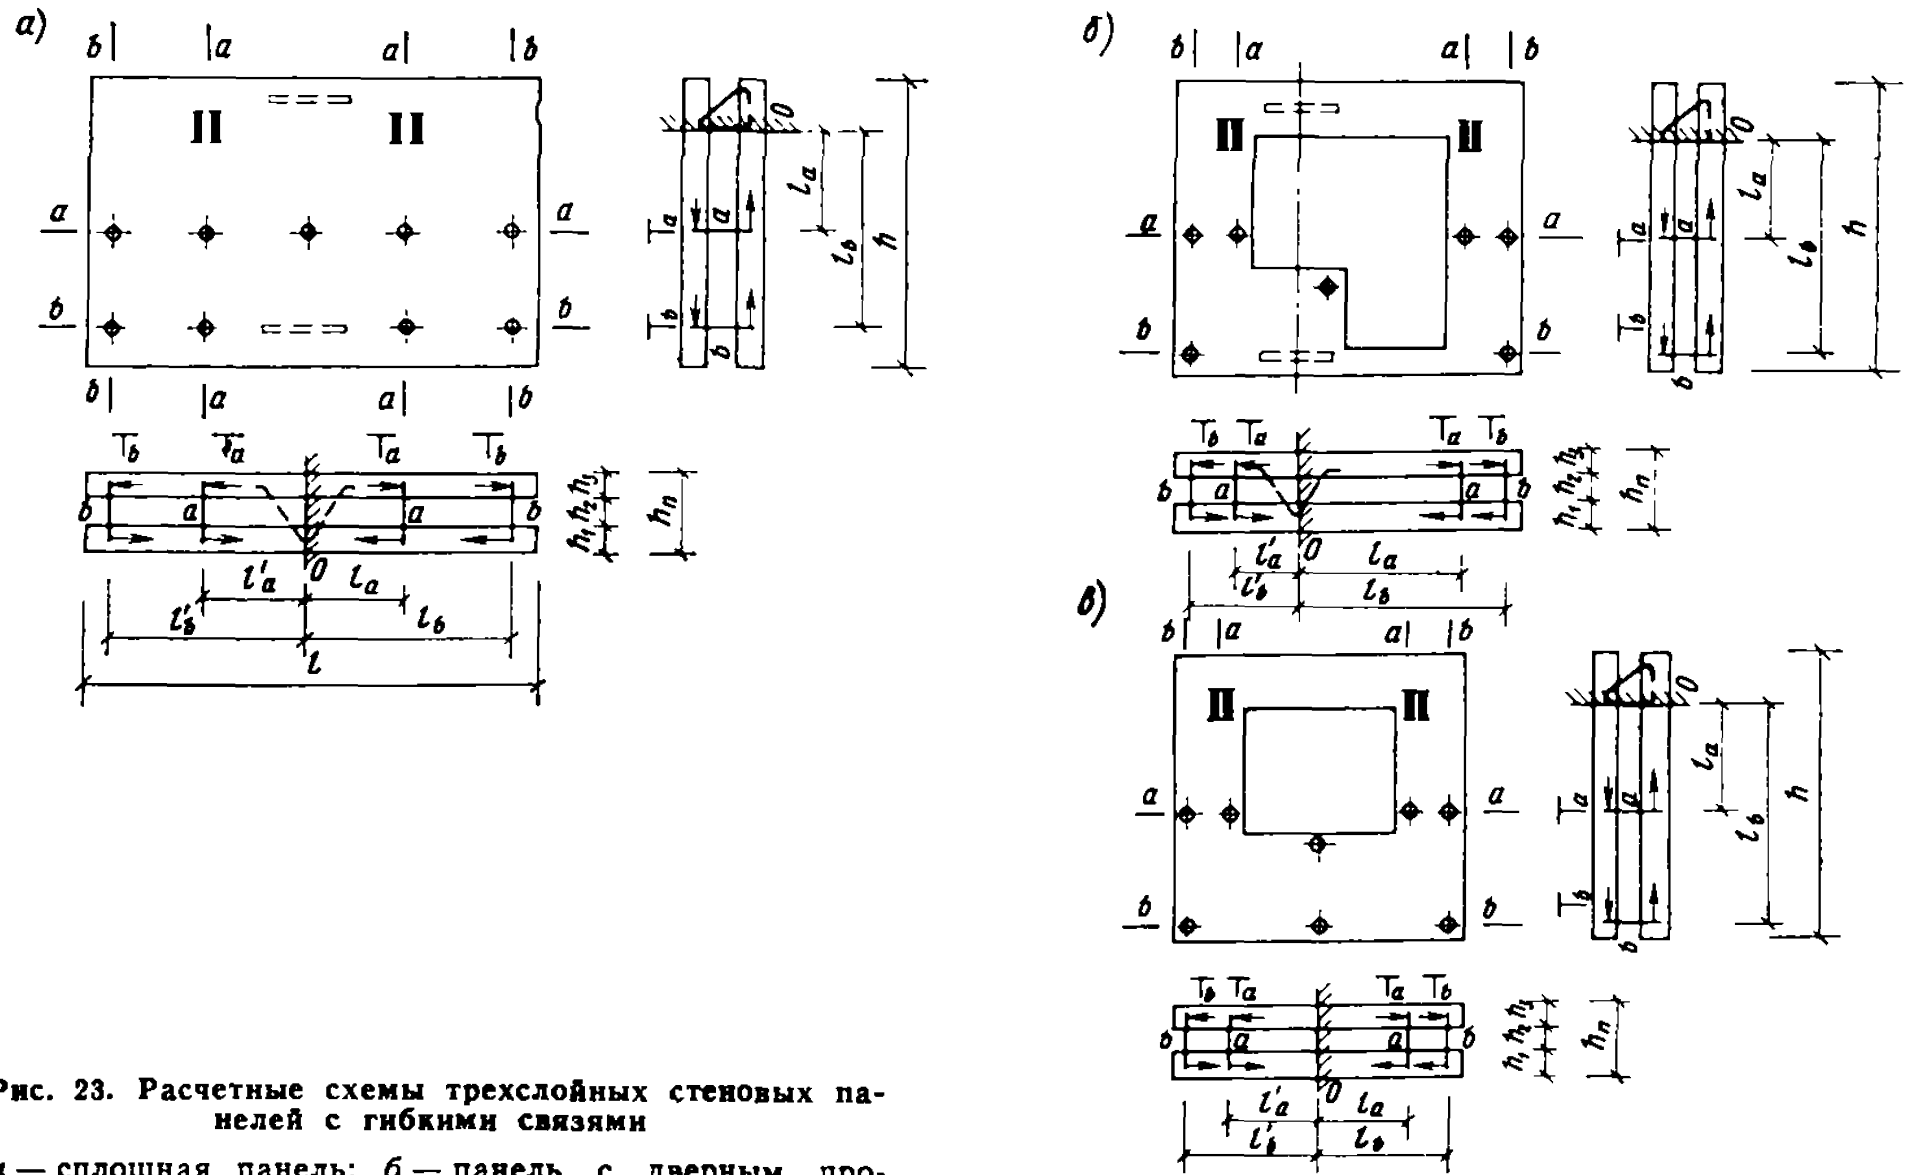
Расчетные схемы трехслойных стеновых панелей с гибкими связями
